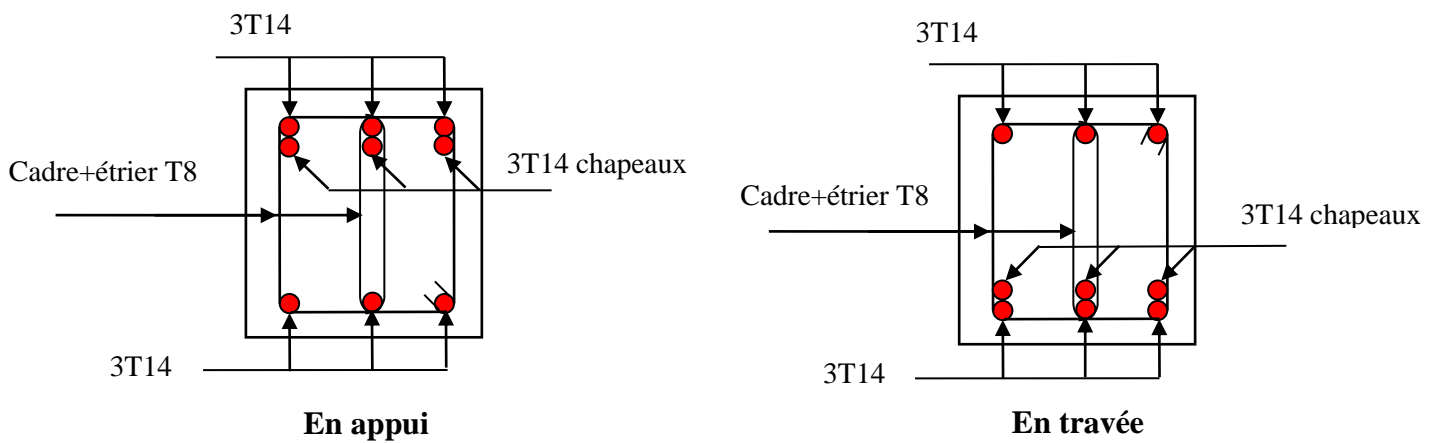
Schémas de ferrailage des poutres principales étage2+étage 3
